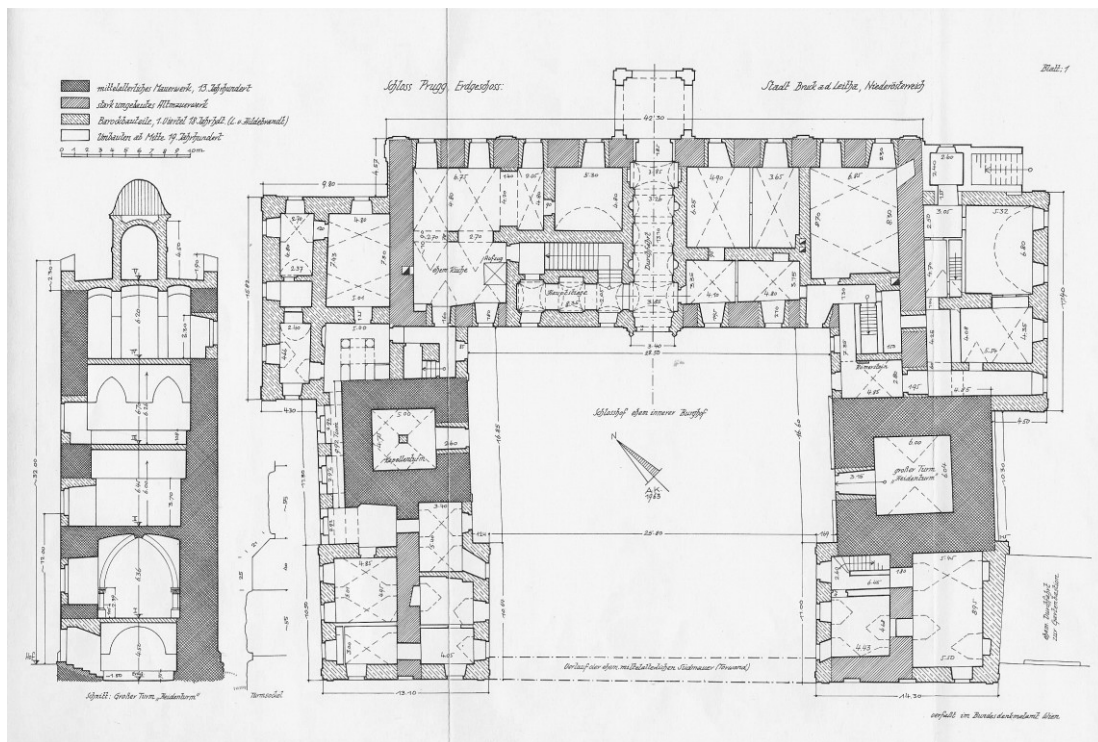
Baualterplan Schloss Prugg, Plan1, Blatt 1/Erdgeschoss, A. Klaat, Bundesdenkmalamt Wien, 1973 (Quelle: KLAAR 1973)
